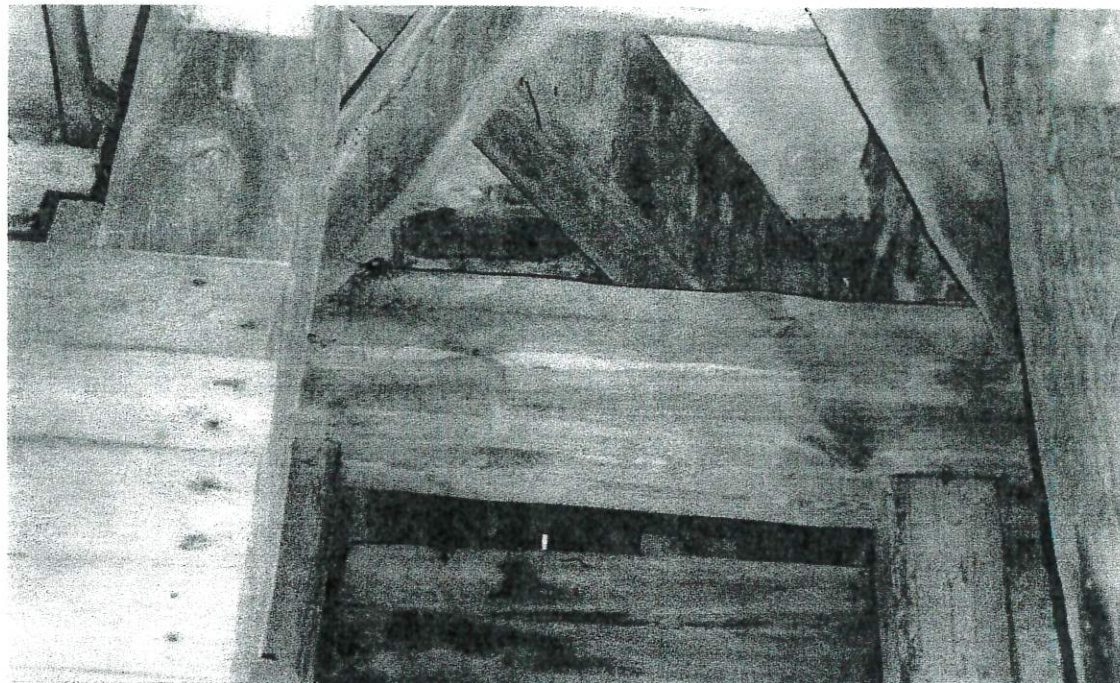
konstrukcja trzonu wieży, poziom belek oczepowych pod kopułą dolną (hełmem)
